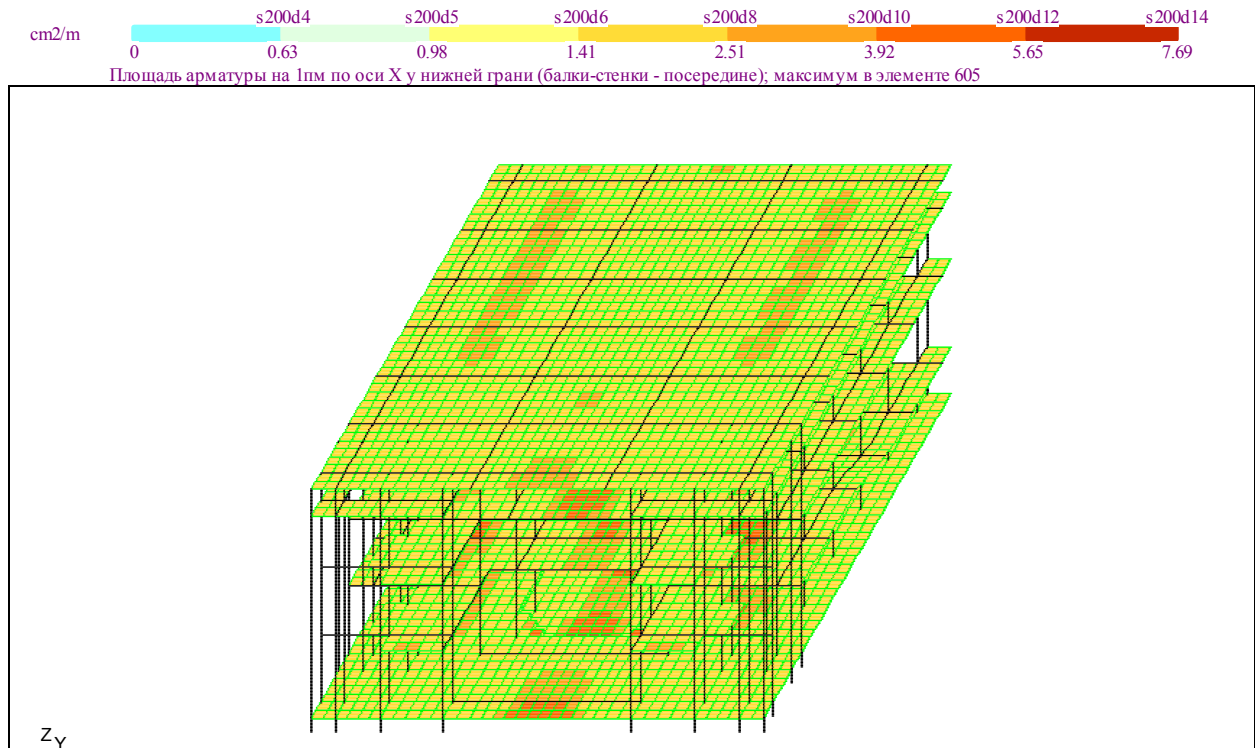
Площа нижньої арматури на 1 пм з урахуванням трещиностійкості по напрямку осі X1
